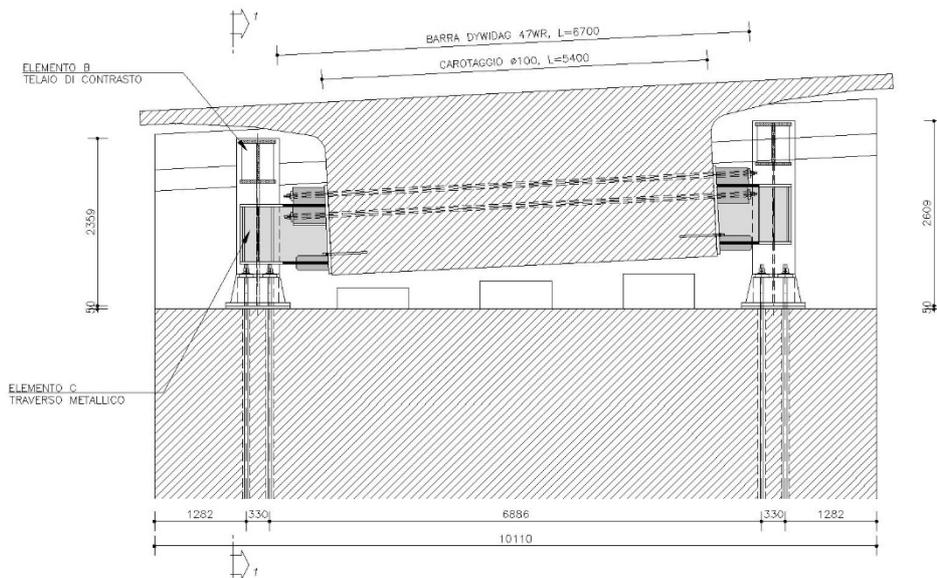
Spalle Sp.2 e Sp.4 - Sezione trasversale in asse appoggi
